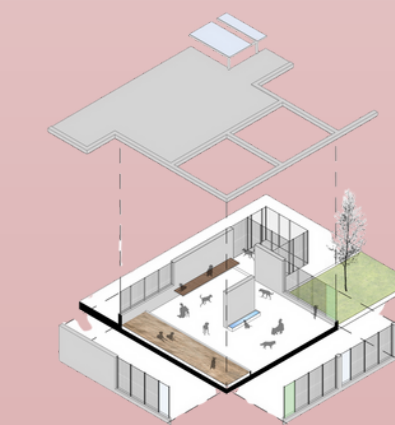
Planta canil Centro Social Veterinário Pako Street - Fonte ArchDaily 2022.
